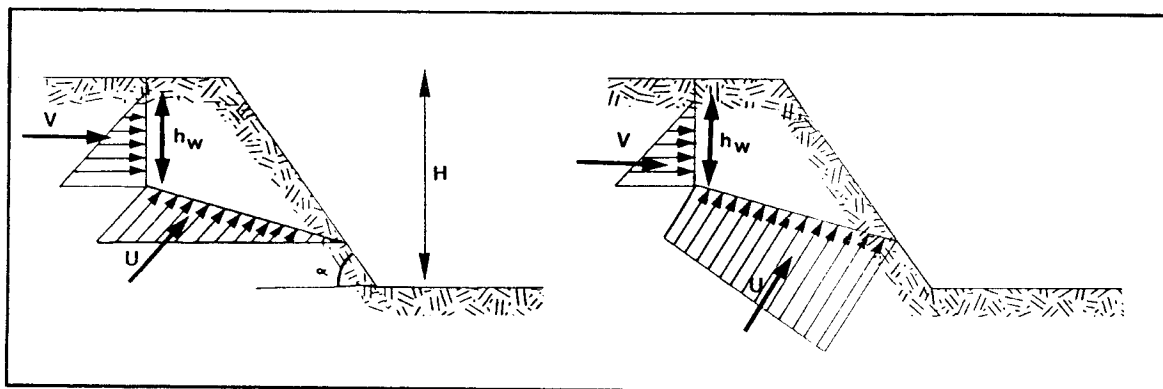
Empujes de agua en una rotura plana con grietas de tracción, en dos hipótesis de carga.
